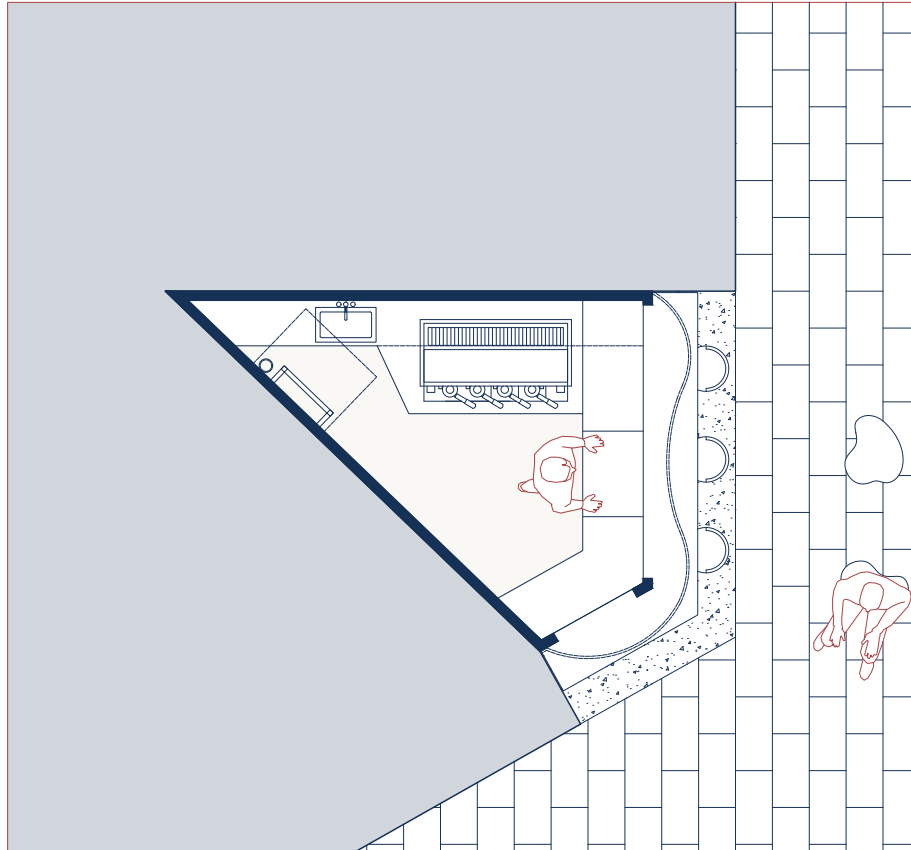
Pianta piano terra, Rielaborazione propria - scala 1:50
